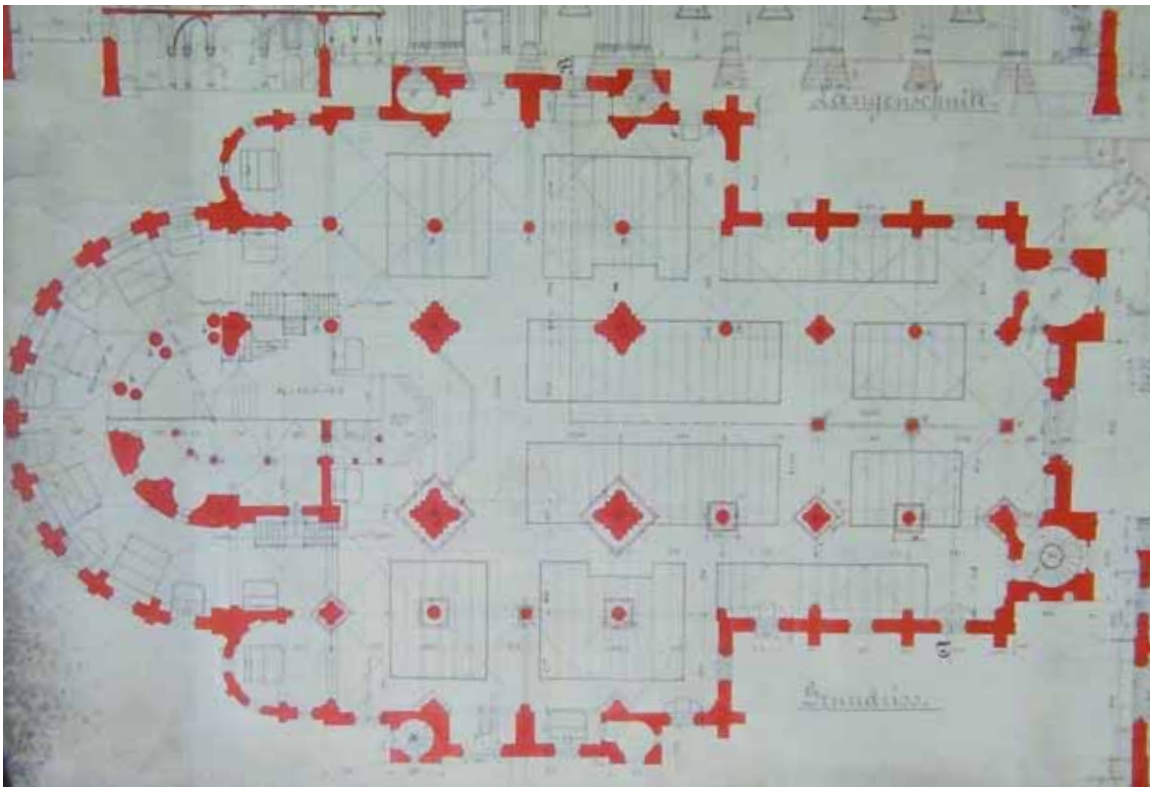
Grundriss, St. Gabriel. Nicht umgesetzter Plan
